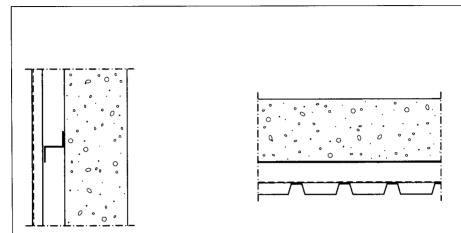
Außenwandbekleidung ohne Wärmedämmung vor Gasbetonwand
